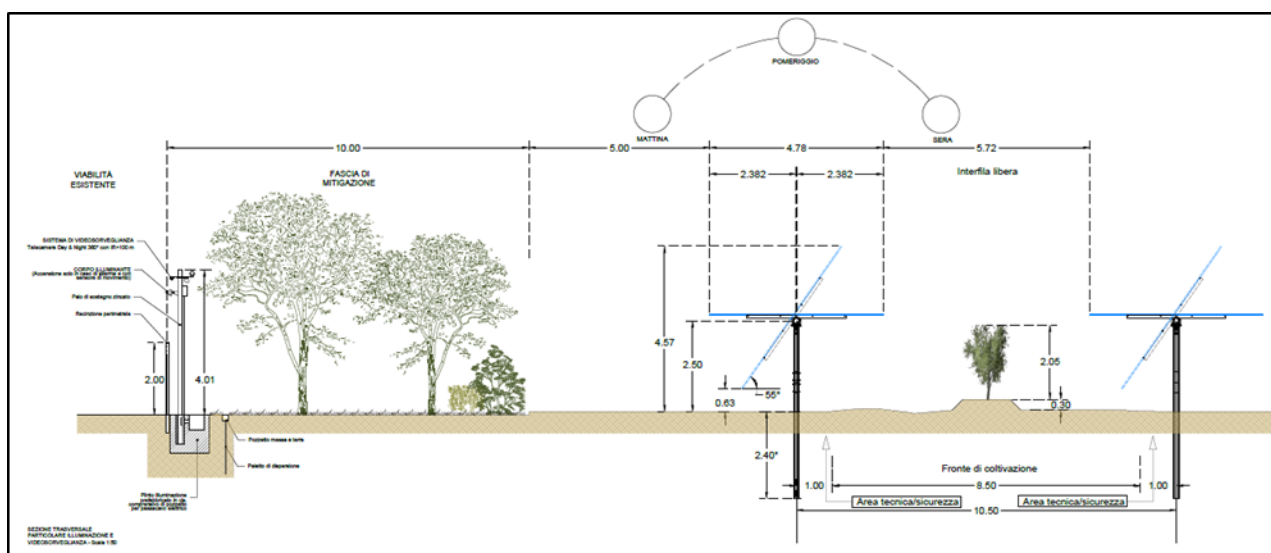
Particolare costruttivo sezione trasversale tipologica impianto con le dimensioni di progetto fuori scala.
